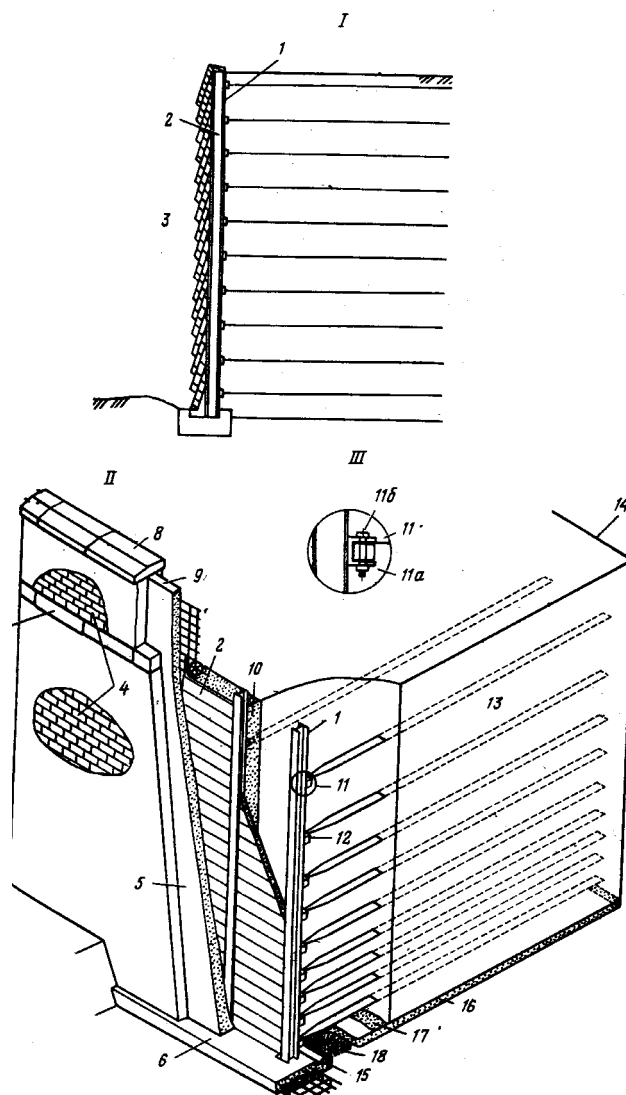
Конструкция стенки из армированного грунта с наружной облицовкой каменной кладкой
